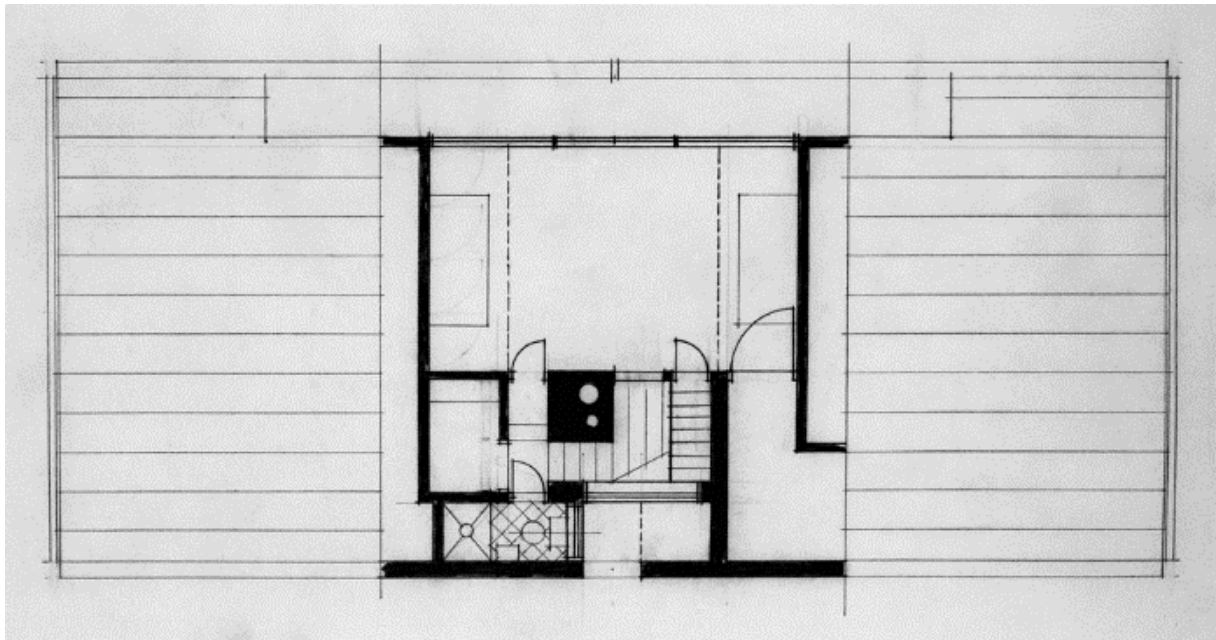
Planta primeiro piso da Casa Vanna Venturi, Robert Venturi
